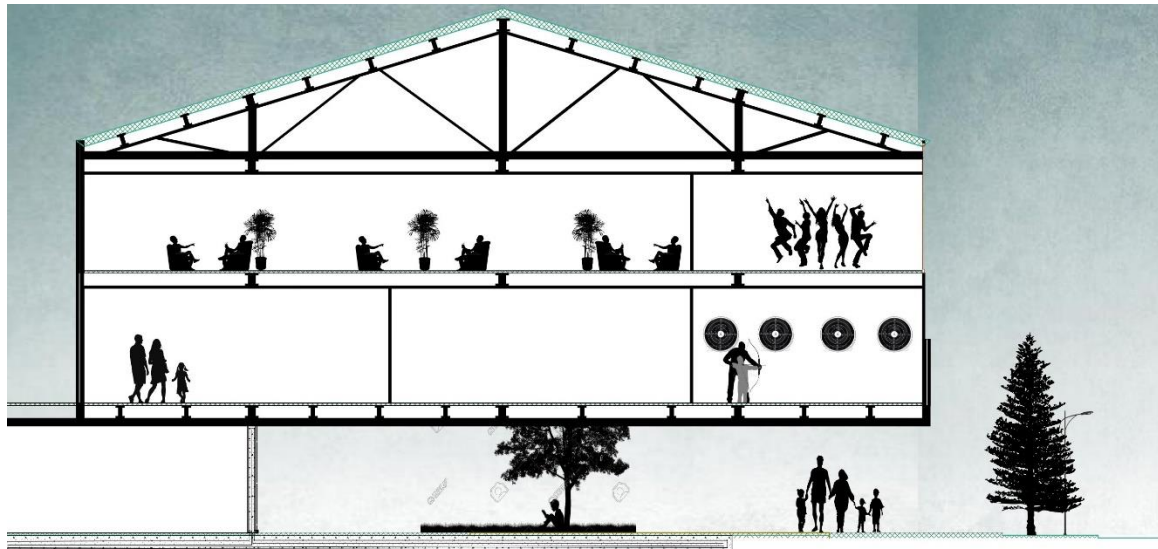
Coupe montrant l'utilisation de la poutre habitée dans le projet
